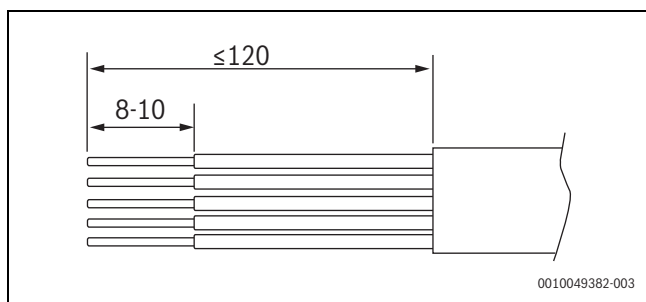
Spelatura dei fili per il collegamento alla rete (mm)
